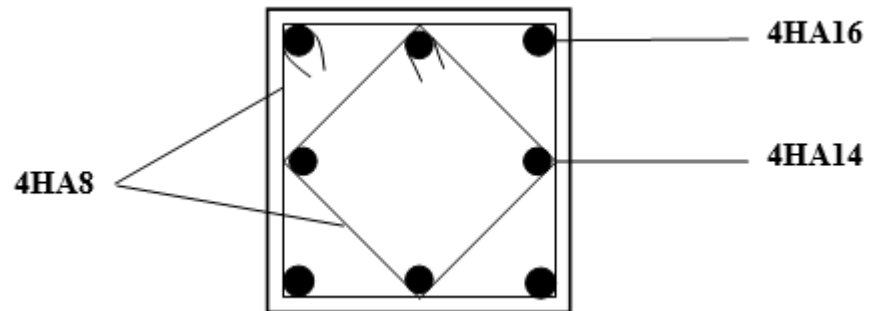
Schéma de ferraillage du poteau 3,4,5^{ème}, étage.
